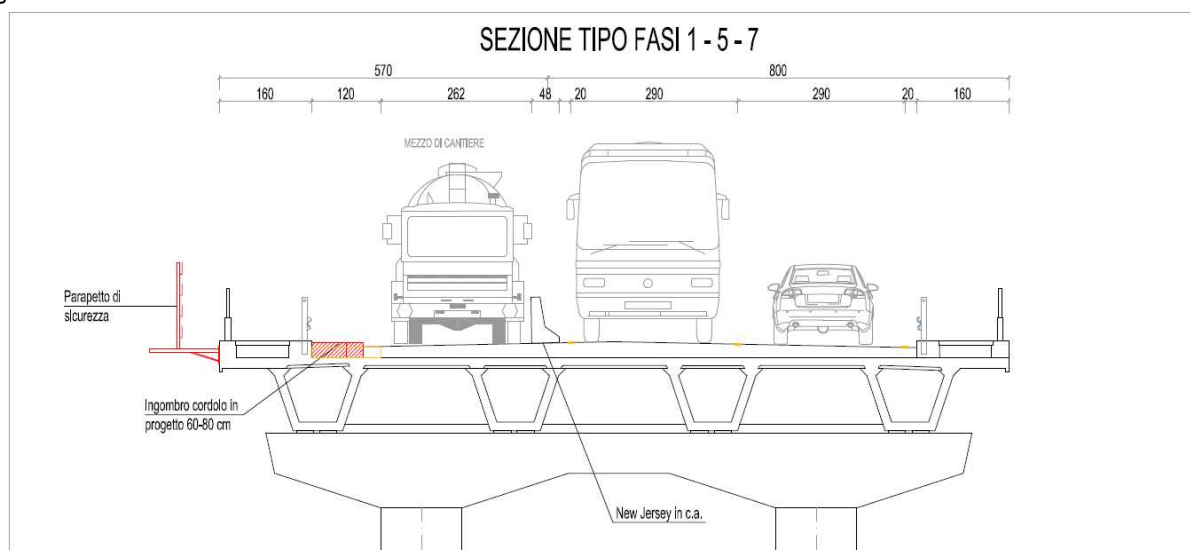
Individuazione dell'area di cantiere, relativamente alla 1° fase operativa, sulla base dell'ingombro dei mezzi di cantiere e del New Jersey in calcestruzzo armato
